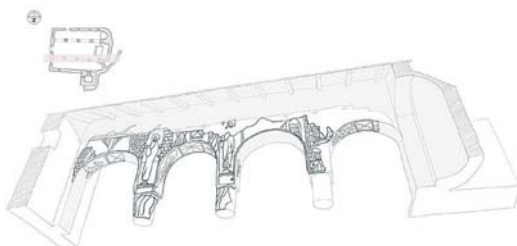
Sant Joan de Boí: croquis del muro norte, nave sur.
